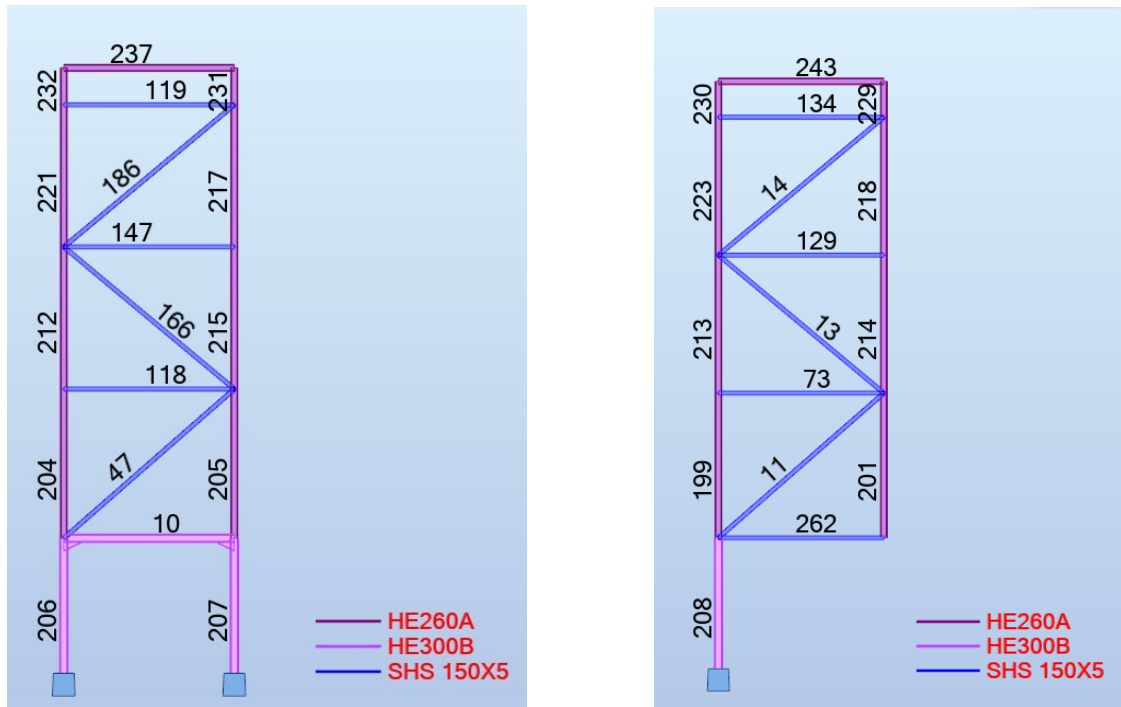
Pórtico B com a numeração dos elementos estruturais
